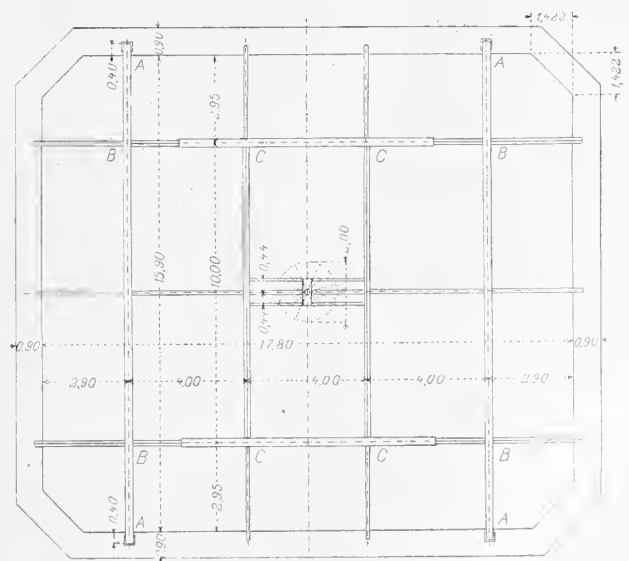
Grundriss des Bodens unter der Kuppel. — Masstab 1:250.
